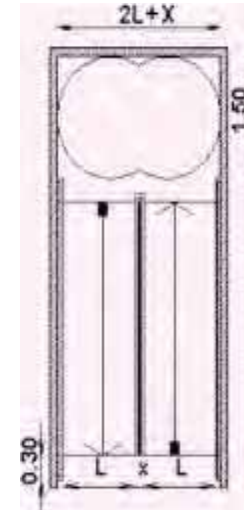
se muestra el ancho mínimo y la fórmula para poder obtener el ancho de la rampa.
